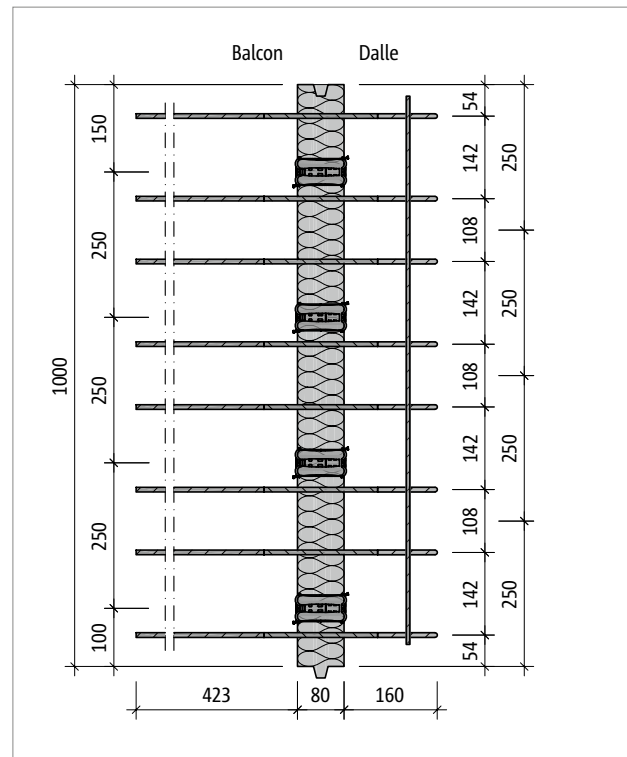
Schöck Isokorb® T type Q-E-W-V4 : plan de base du produit
